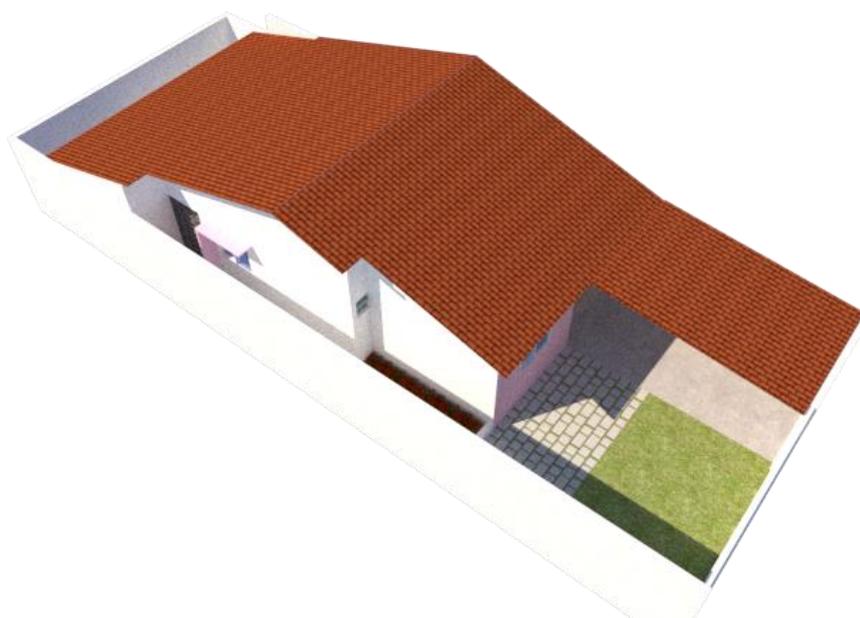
Proposta espelhada orientada à Sudeste - Fachada lateral
